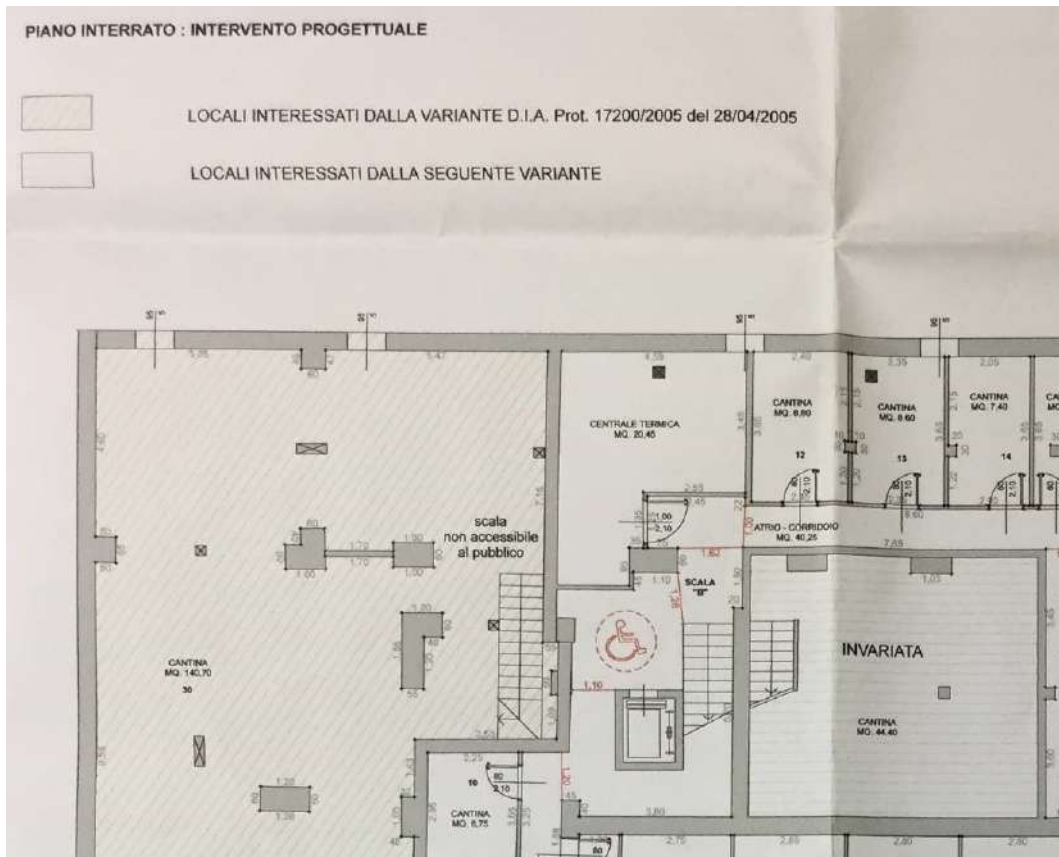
Estratto Tavola 2 allegata alla D.I.A. del 14/12/2006 Prot. 54093 - Pianta piano primo interrato
